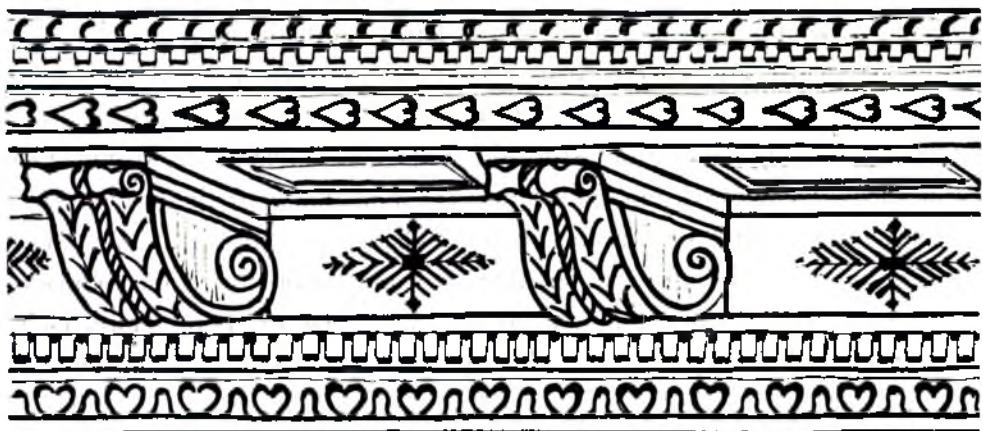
Decoración de la viga principal de la fachada de "Alzatebaita" Lesaca.
